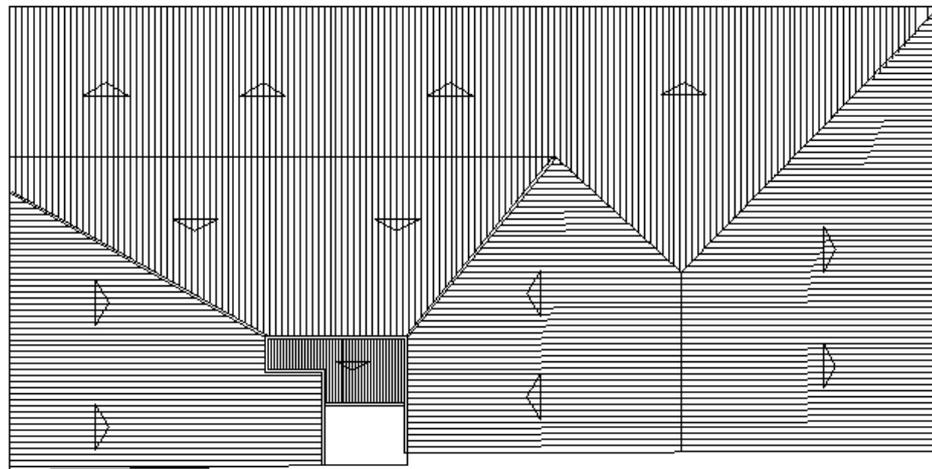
Ilustração de Planta de Cobertura e desenho do lote.
